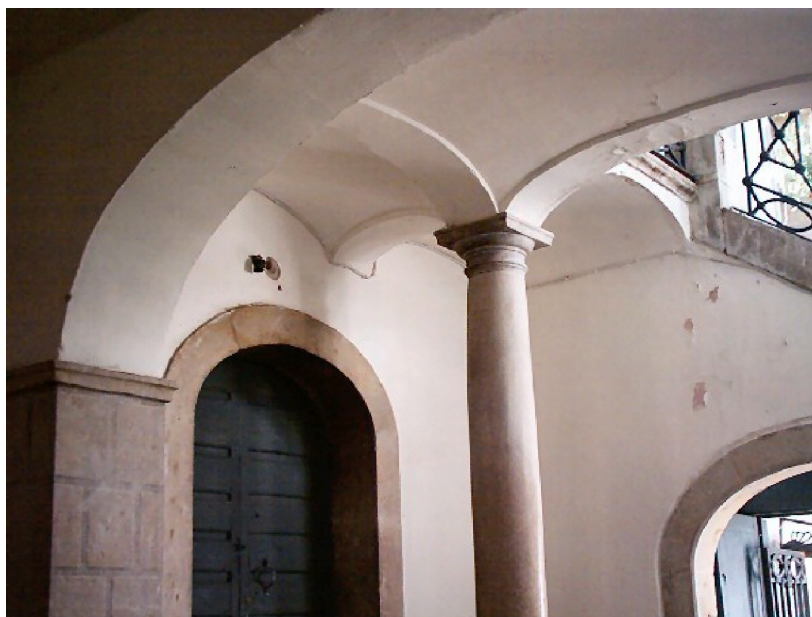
PALAZZO ZAMPARELLI: PARTICOLARE COLONNATO E ARCADE
